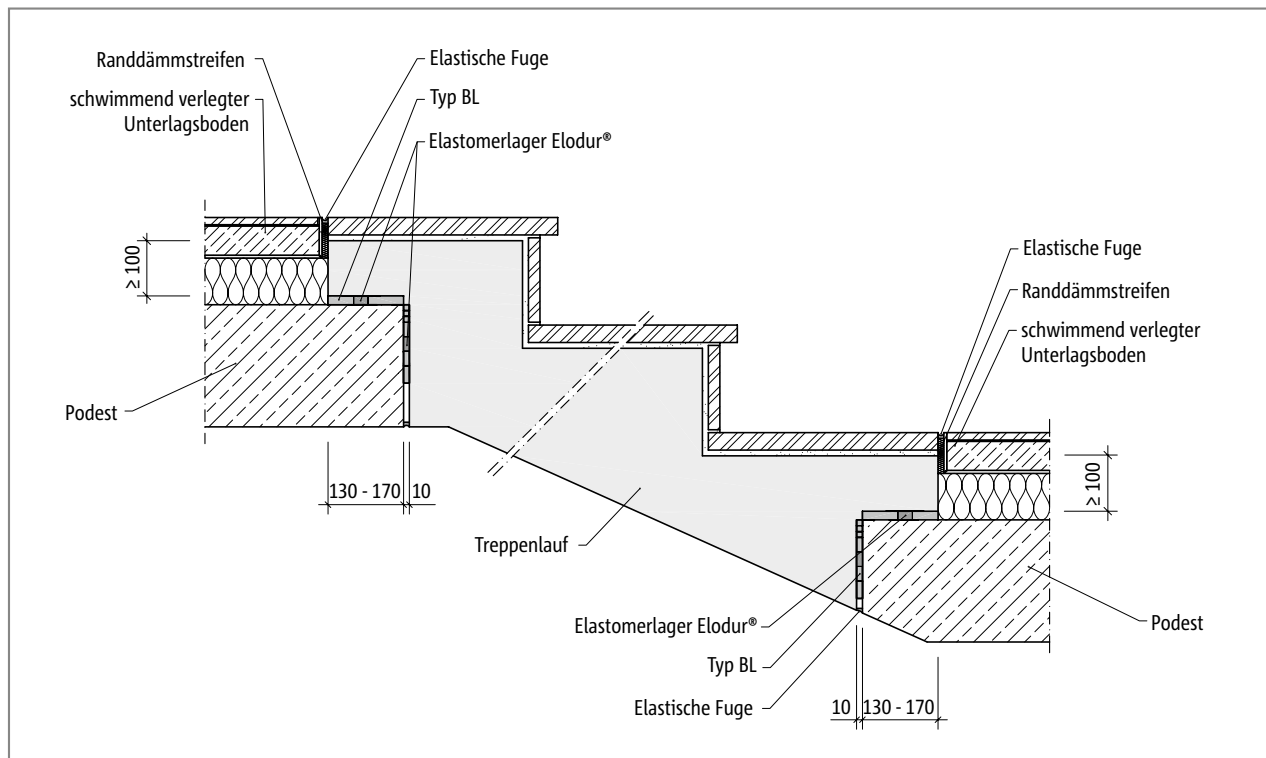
Schöck Tronsole® Typ BL: Einbauschritt
